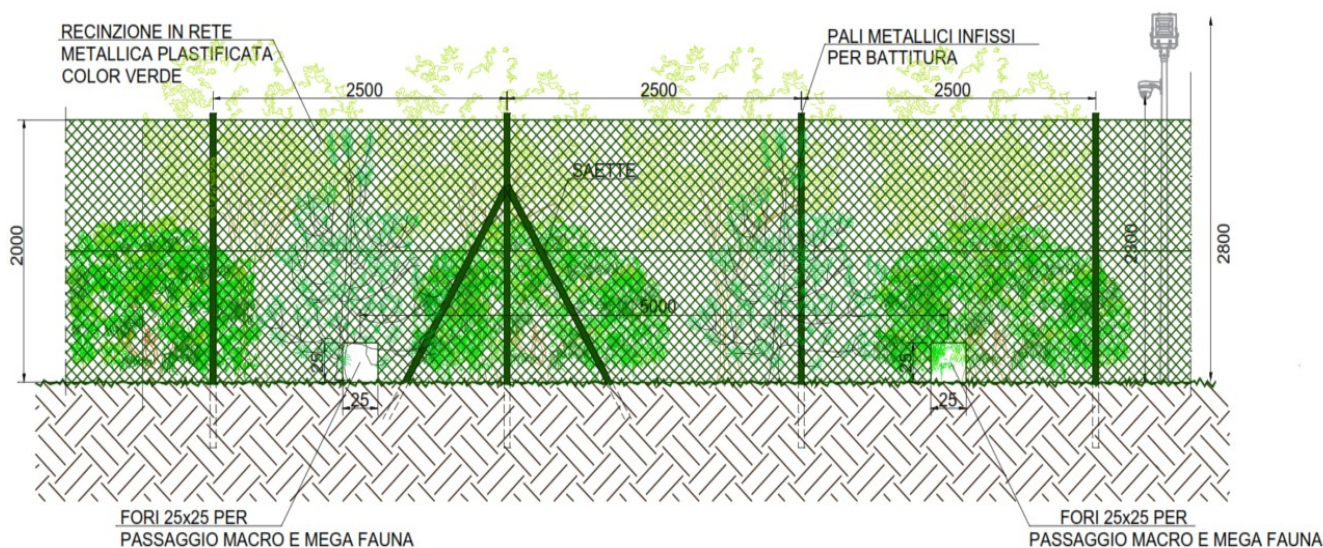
Prospetto delle opere di mitigazione e recinzione perimetrali
